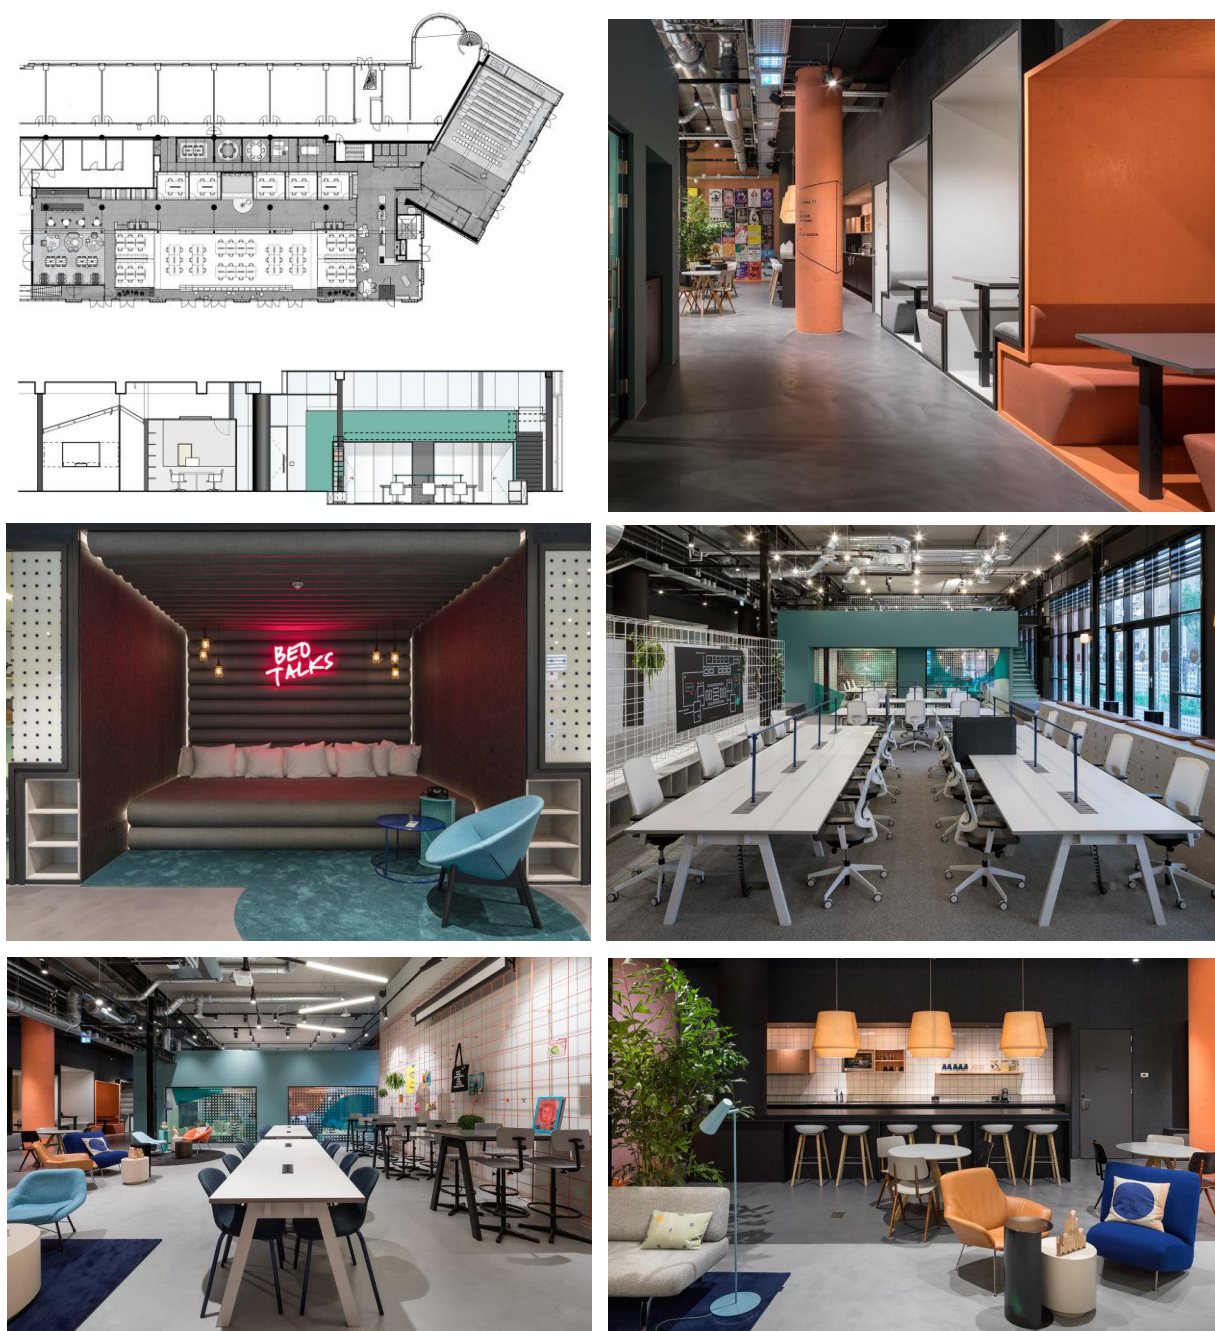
Planta e fotografias do interior. Fonte: Architonic.
